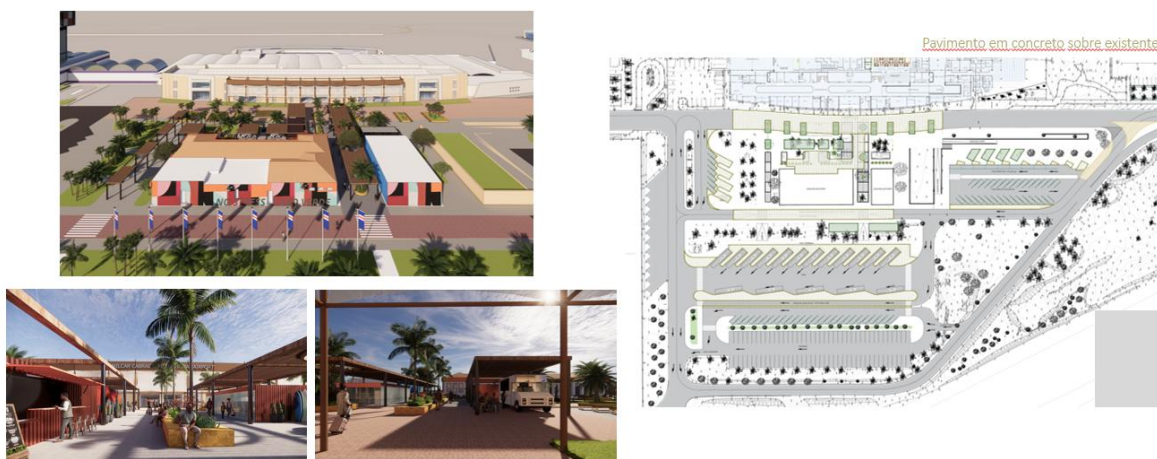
| Trabalhos arranjos área exterior – Localização e Vista 3D
